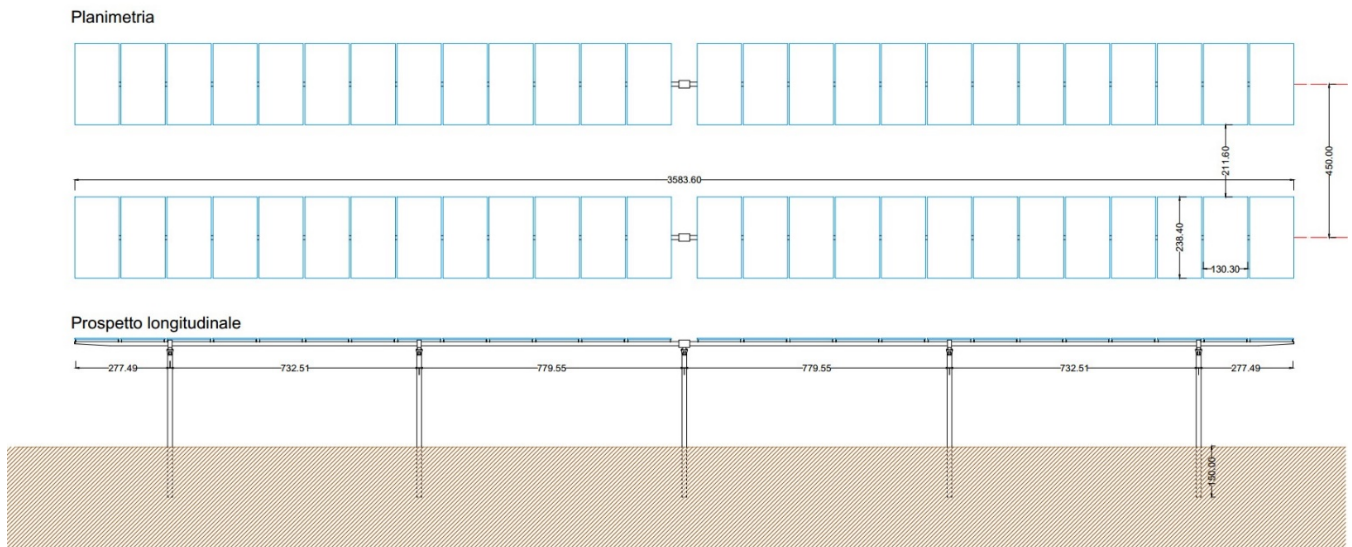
Planimetria e prospetto longitudinale struttura tracker
